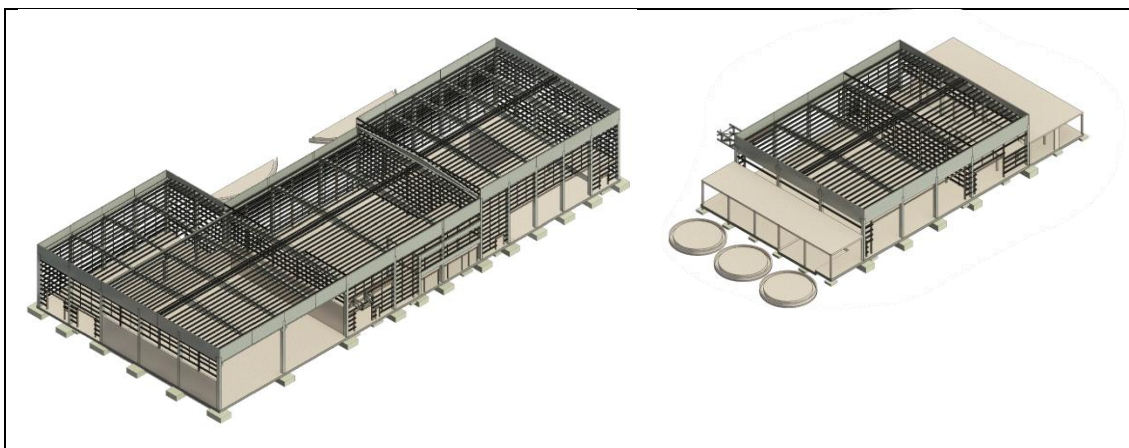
Estrutura de betão armado e metálica dos edifícios industriais
